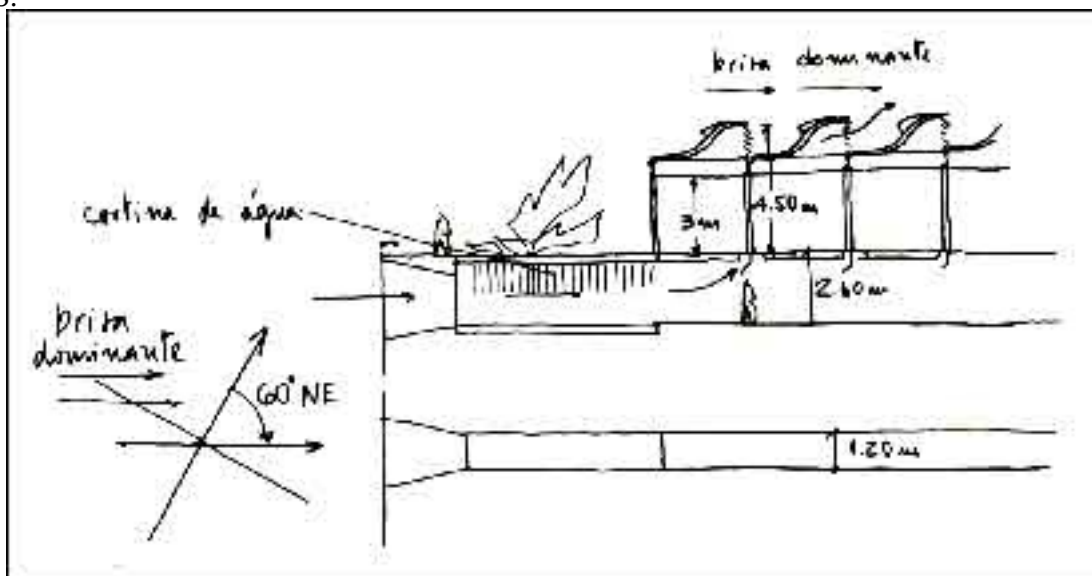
Corte e planta baixa em croqui de duto que compoñe um sistema de ventilação natural utilizado nos projetos da Rede SARAHA de Hospitais. Esse sistema é constituído por um conjunto de corredores, paralelos entre si e perpendiculares aos panos de exaustão dos "sheds", que ficam abaixo do piso do Hospital (LIMA, 1999, p.24)
